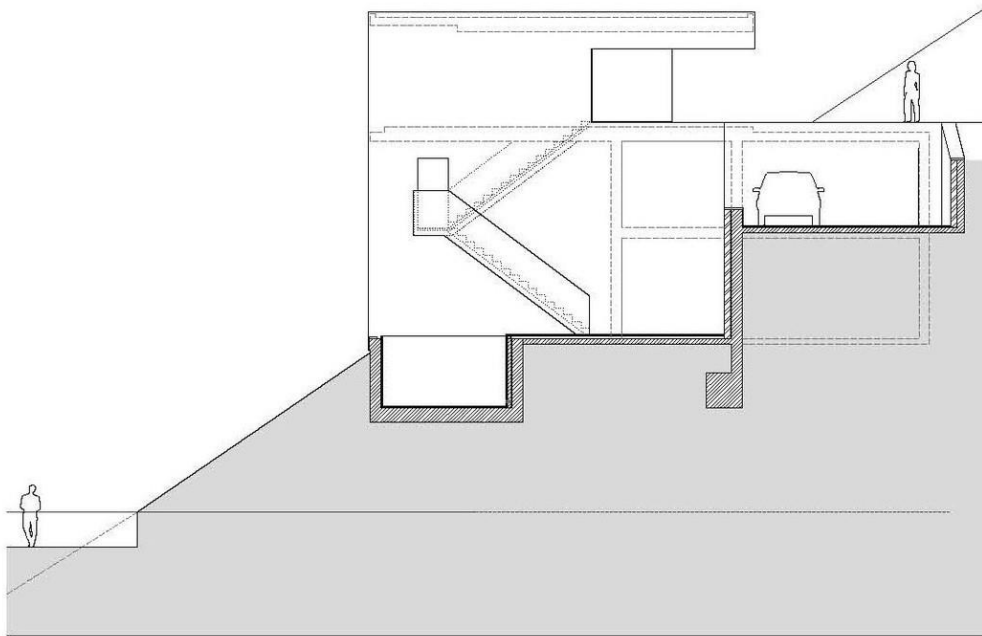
Alzado suroeste. Fuente: Fran Silvestre Arquitectos.
